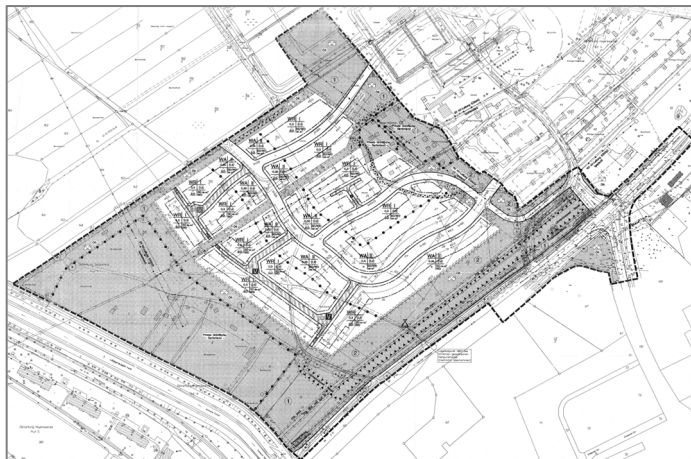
Abbildung B: rechtswirksamer Bebauungsplan (Quelle: Stadt Hoyerswerda)
